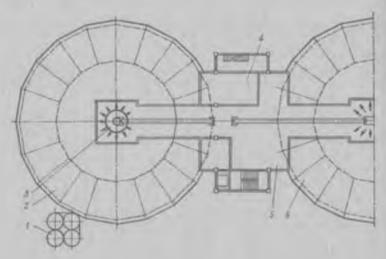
Автоматизированный семяобрабатывающий элеватор: 1— вентилируемый бункер БВ-100; 2, 6— силосные корпуса № 2 и 1; 3— поворотная труба ТР-12-2; 4— диспетчерская; 5— рабочая башия
